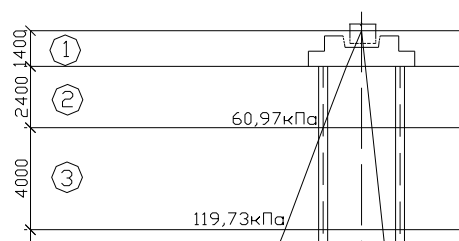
Схема до розрахунку осадки фундаменту
